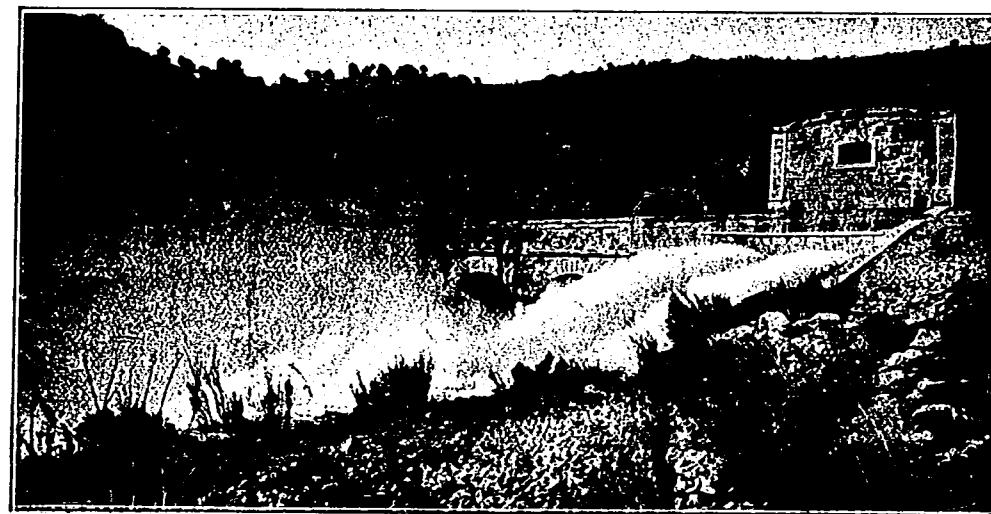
Sifón del Guadalix.—Desagüe de fondo. Kilómetro 38.
